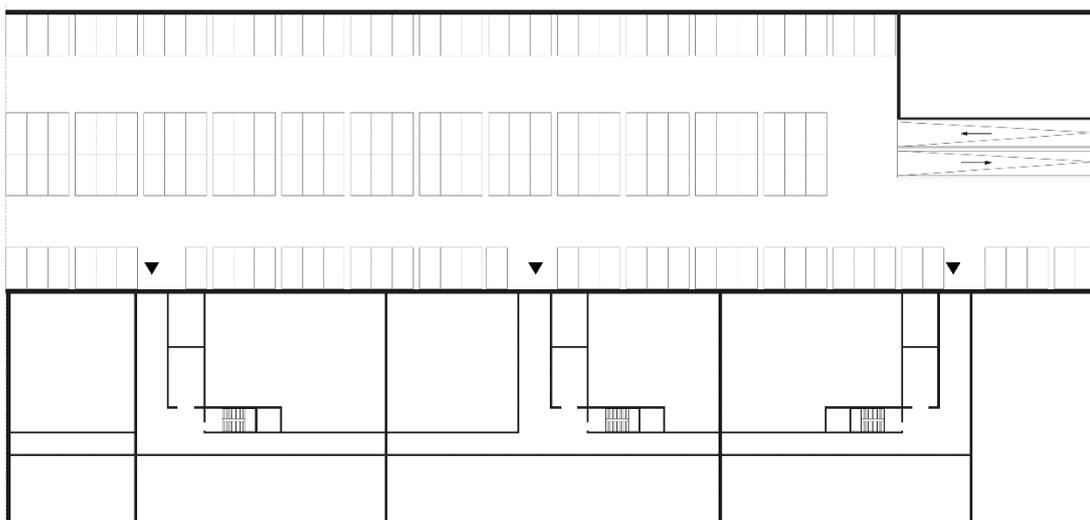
Vorentwurf Grundriss Untergeschoss Kleingewerbe
